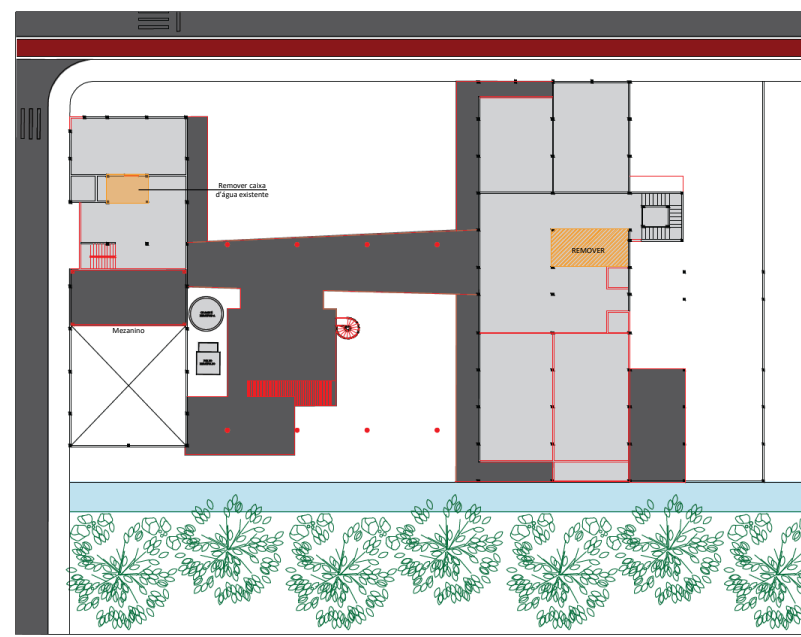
Planta baixa reforma | 2º Pavimento - Proposta
